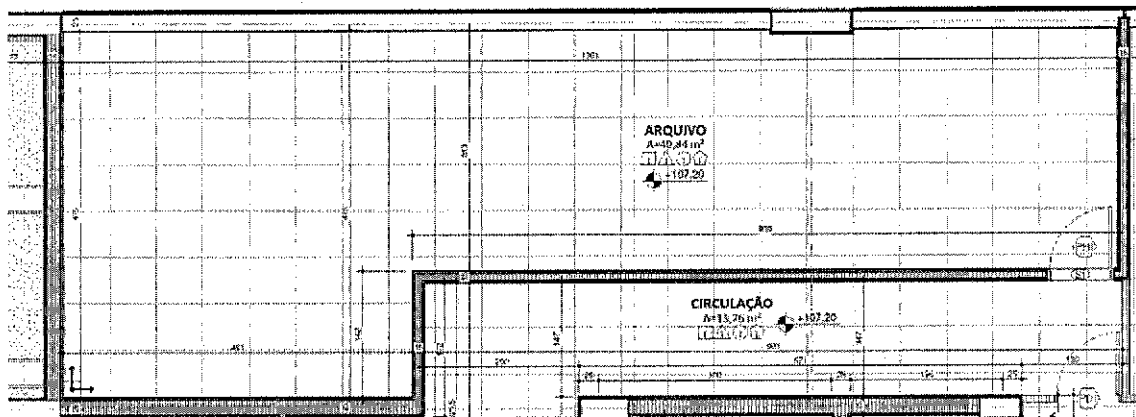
planta do 1º pavimento da obra DRF Bauru (CAT 2620180009585), área de arquivo com 49,84m². Obra de Construção.
